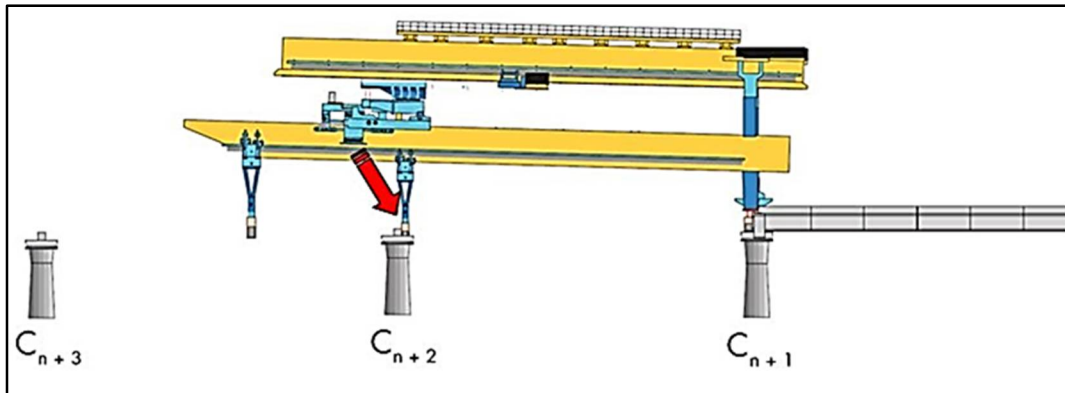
Avance de la viga lanzadora, Fase 2: avance de la viga superior sobre la viga inferior (2)
